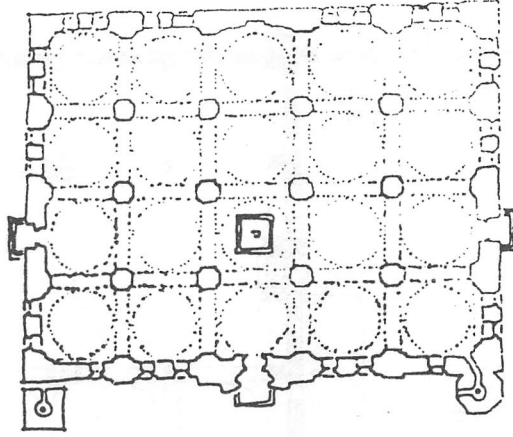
المسقط الأفقي لمسجد 'ولو غ بيتي' في سمرقند
